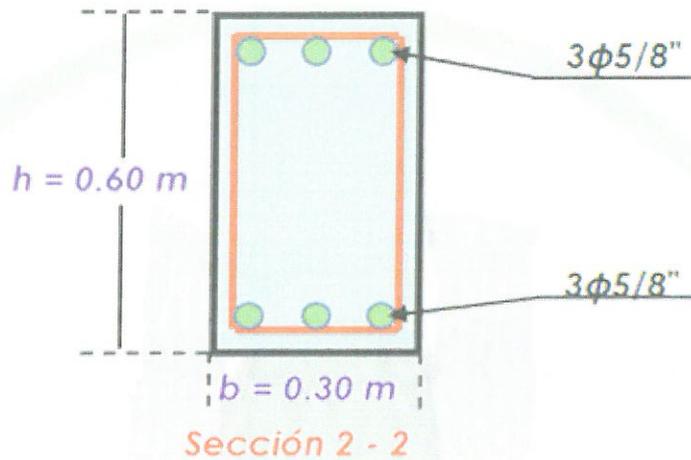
Vista de la altura y distribución de acero de la viga de cimentación
